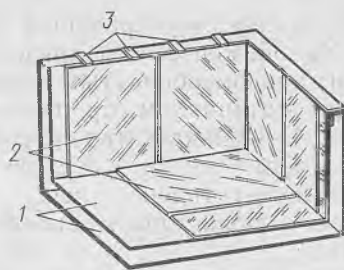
Футеровка хромировочной ванны армированным стеклом:
